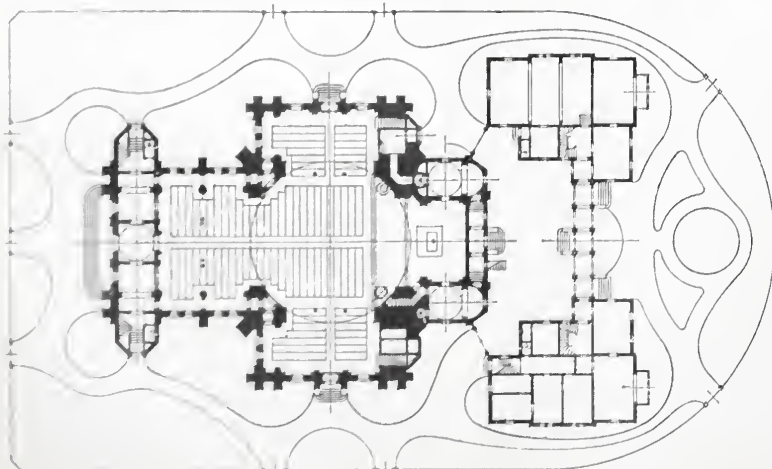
u. 4. Grundrisse zu ebener Erde und in Höhe der Emporen.
